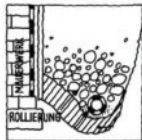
Grundlagen für das Sanieren alter Bauernhöfe
